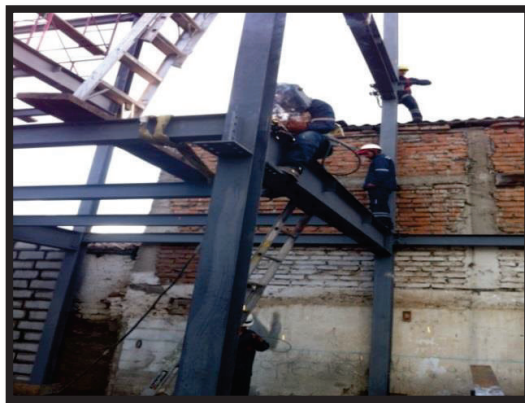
Viga en estructura metálica Cayambe-Ecuador.
